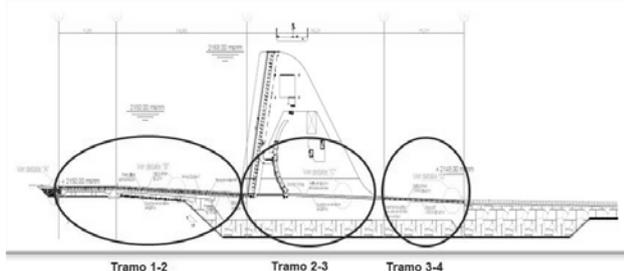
Sección transversal de las mejoras a losa de fondo.
